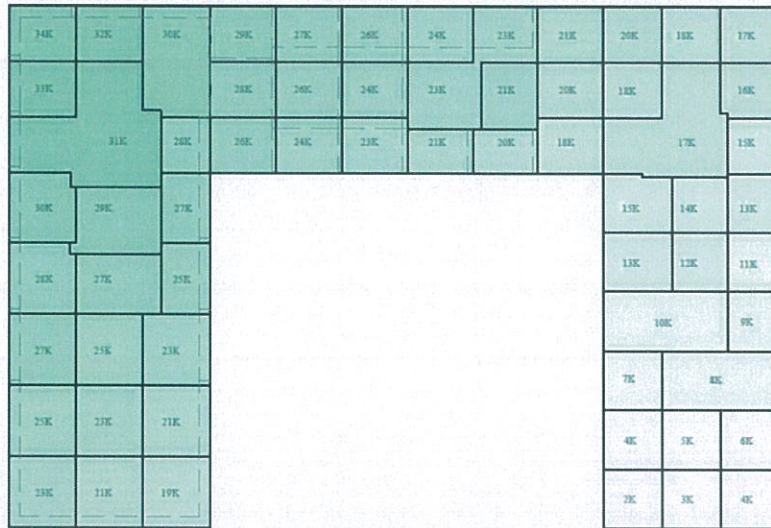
Planimetri e katit +20, në kuotën +72.26
